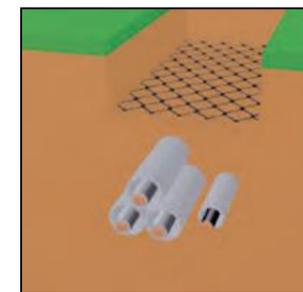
Principe d'enfouissement et coupe d'un câble de raccordement souterrain (source : RTE)
